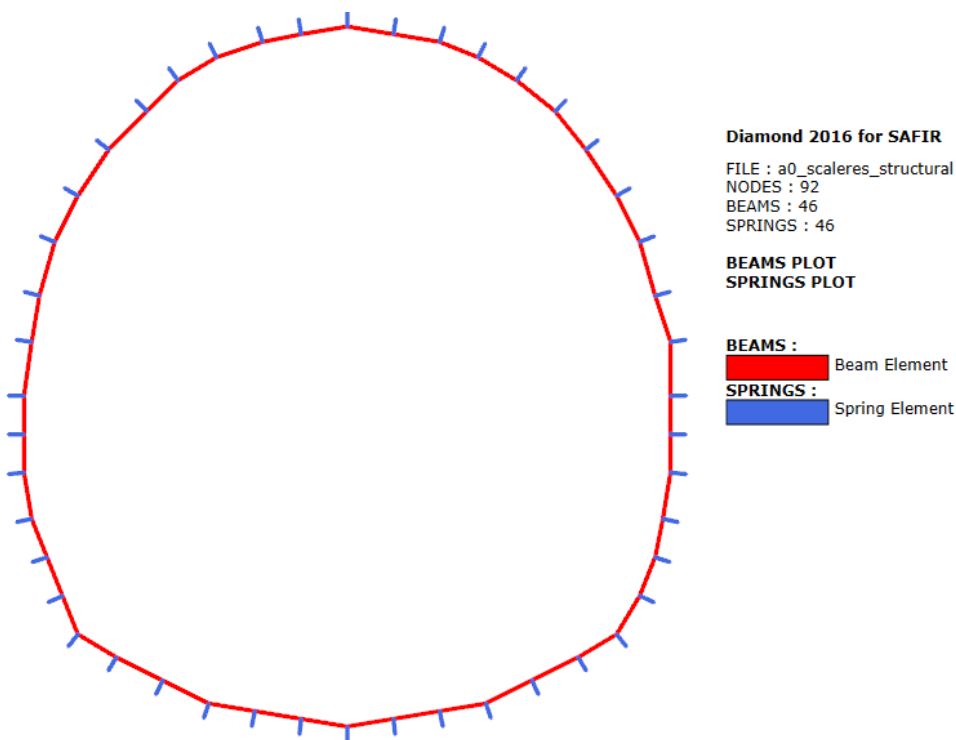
Sezione A0 rappresentata tramite elementi 'beam'
